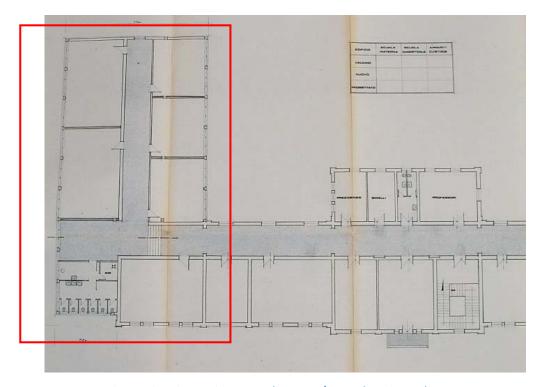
Piano primo – ampliamento/sopraelevazione Blocco B
